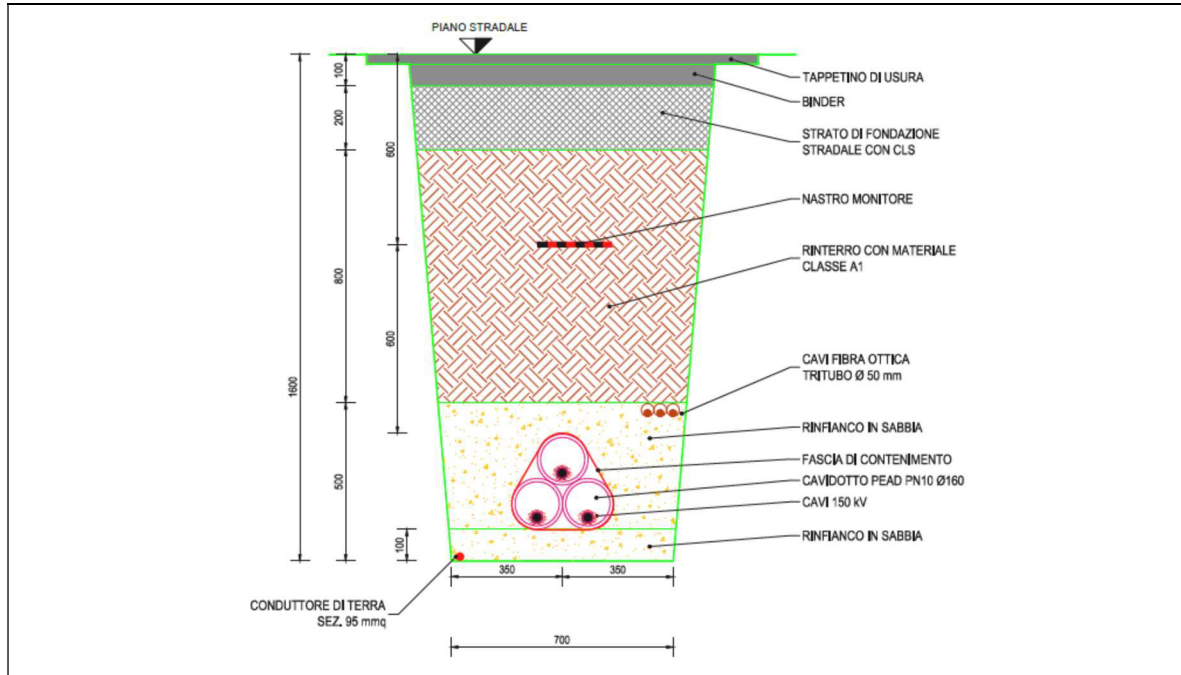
Sezione tipo cavidotto AT su strada asfaltata
